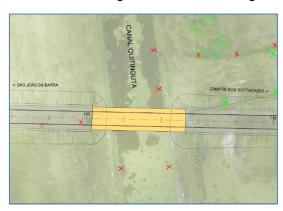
Solução para a transposição do Canal Quitinguita - Est. 105
